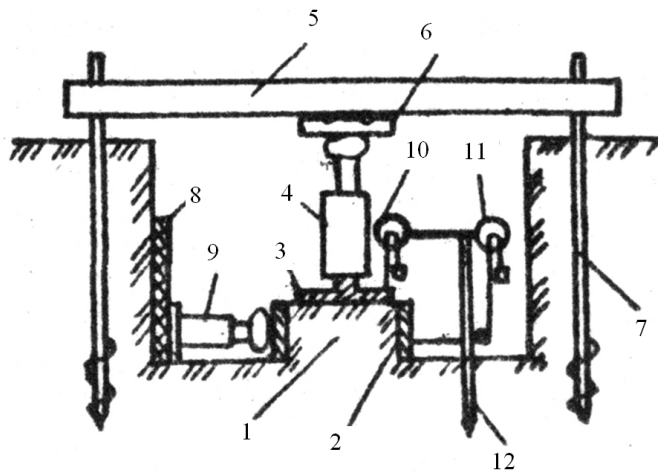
Схема установки для випробувань на зріз ціліку ґрунту
